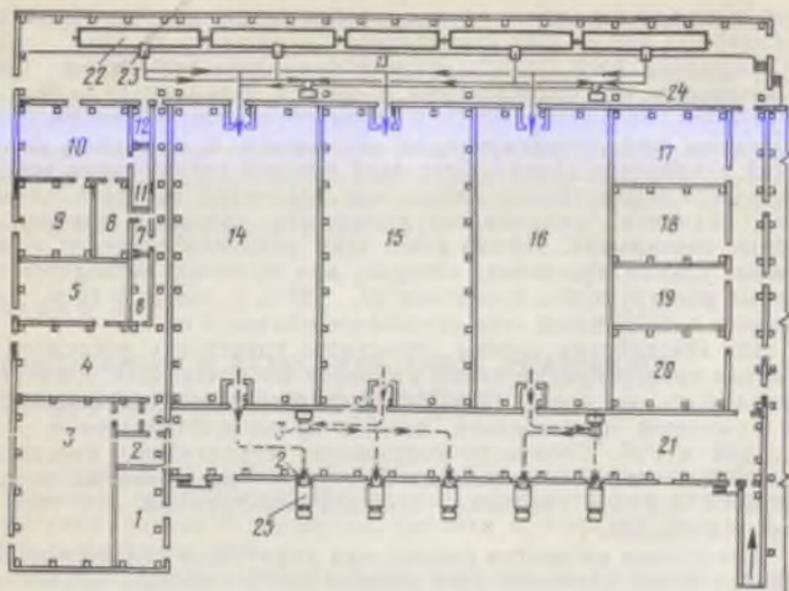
План одноэтажного охлаждаемого хранилища со сквозными камерами хранения:
